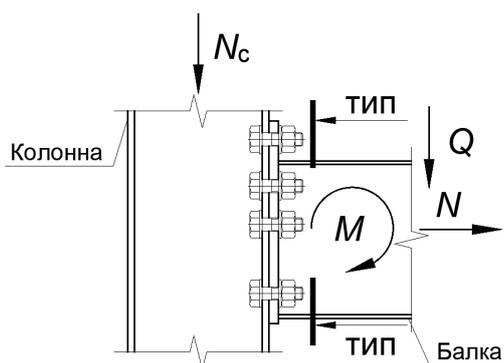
Определение расчетных длин швов стенки балки
